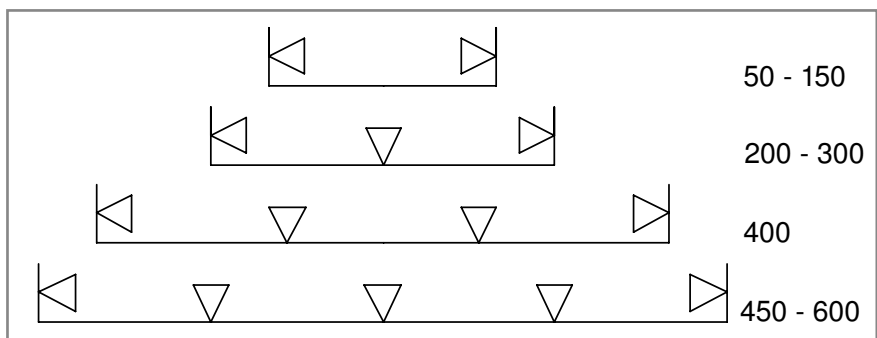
Количество и положение стыковых соединителей на ширину проволочного лотка
